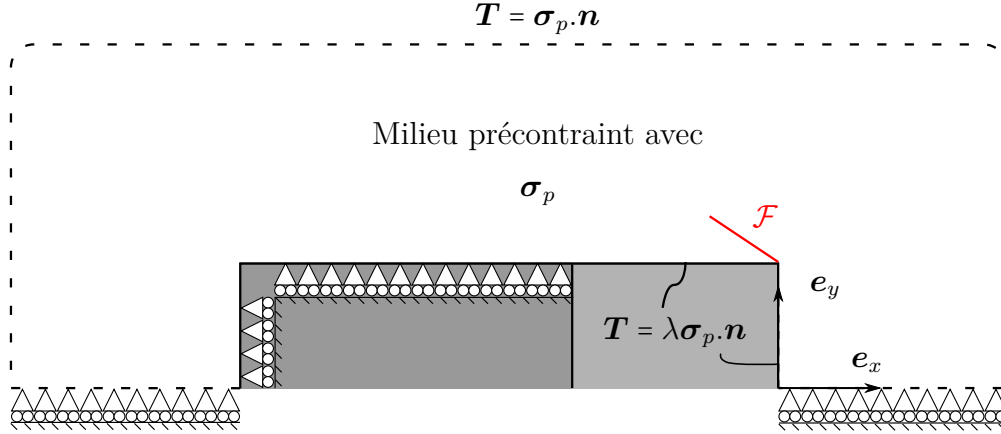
Excavation du tunnel en conditions bidimensionnels avec présence éventuelle d'une fissure \mathcal{F} de longueur l
